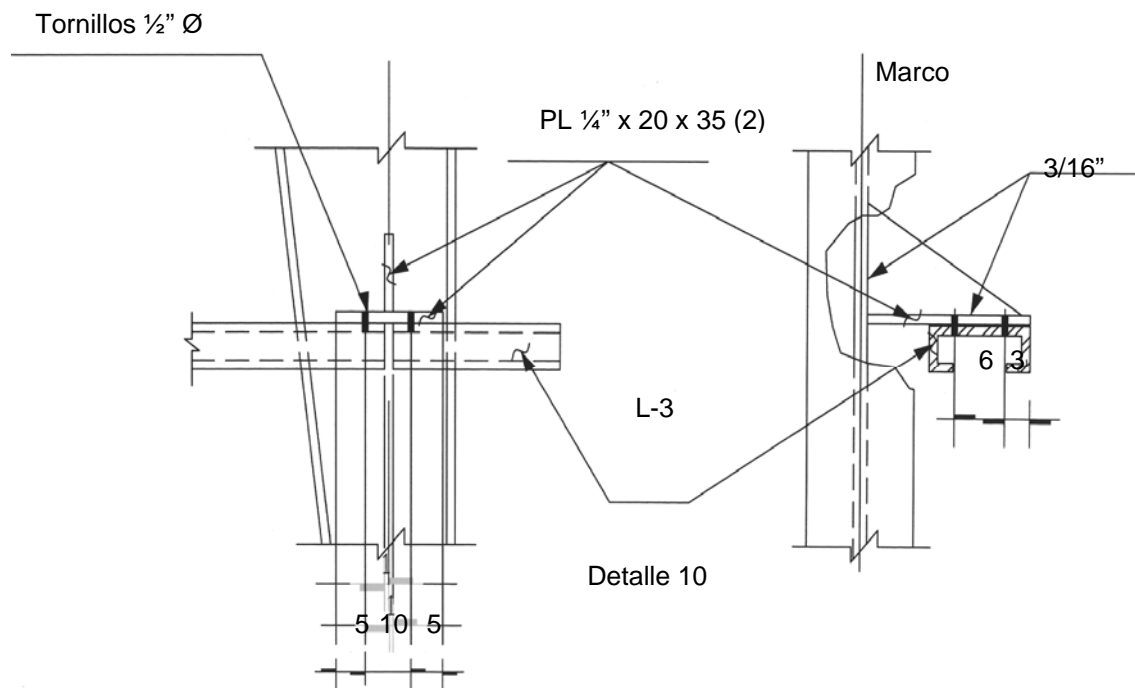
Conexiones de estructura de fachada a marcos MA-1 y MA-2
